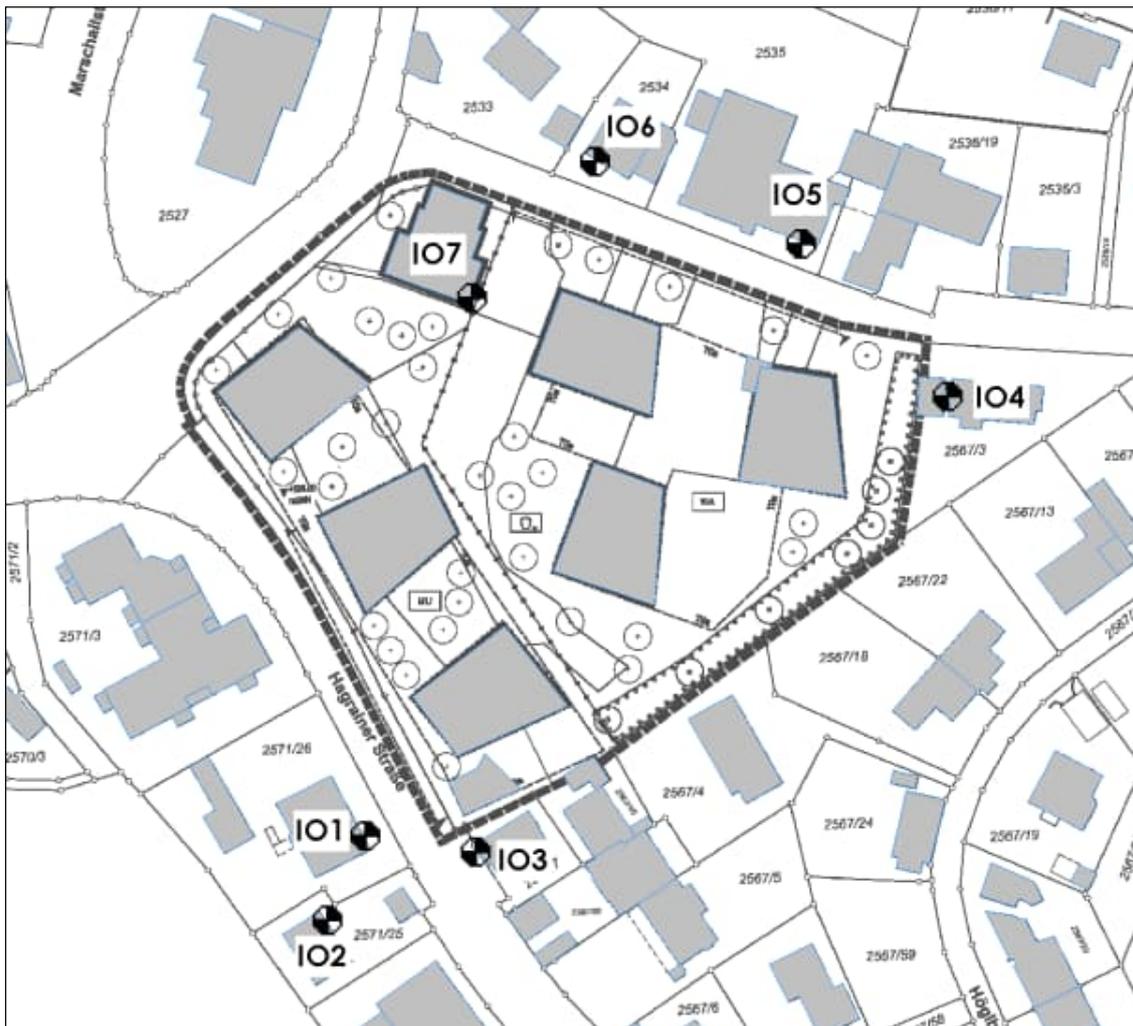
Lageplan mit Darstellung der maßgeblichen Immissionsorte
